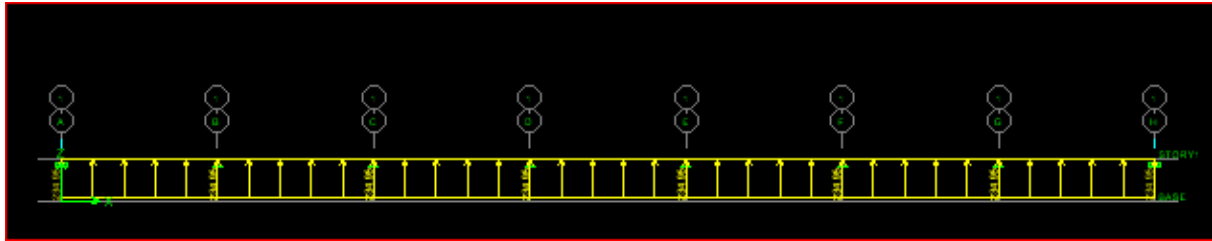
Schéma statique de la nervure ELU (sens longitudinal).
